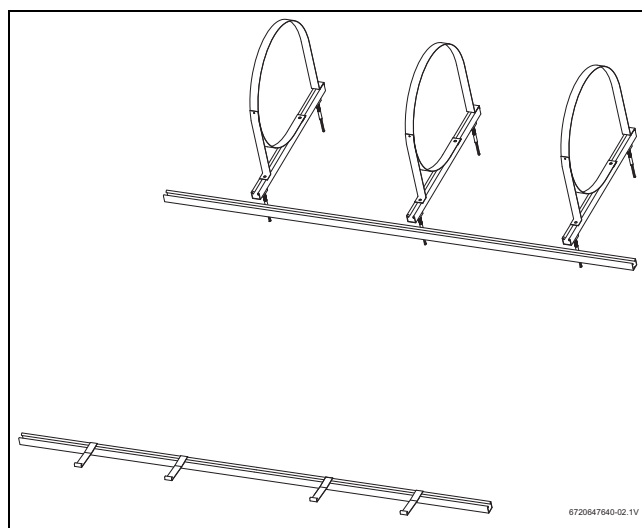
Vista de conjunto del soporte para tejado inclinado (sistema de 300 l)
